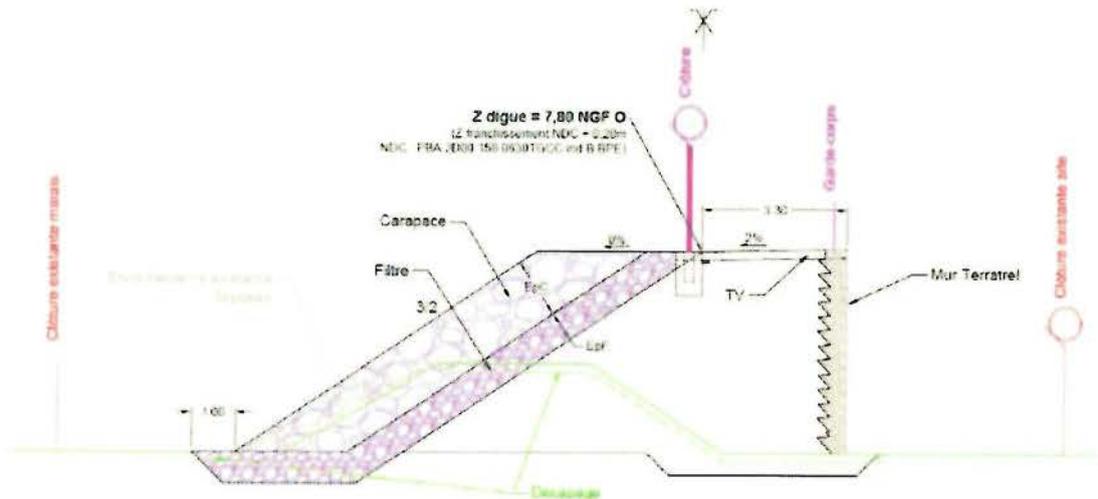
Profil en travers type pour la future digue en zone 1 Est
